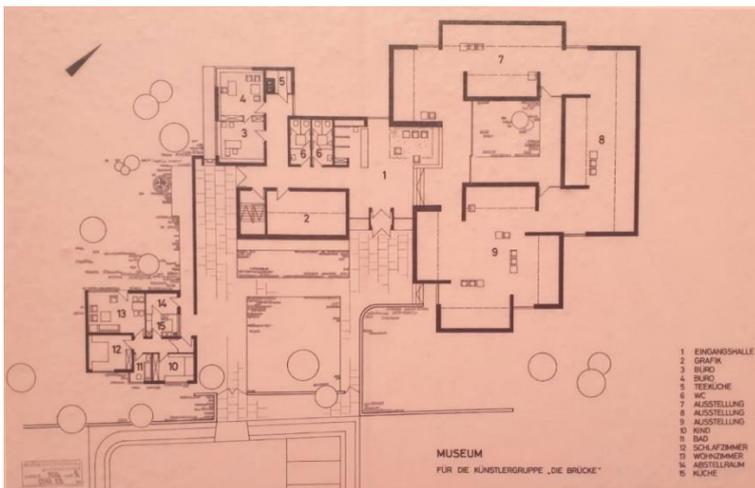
Landesarchiv Berlin: Grundriss Brücke-Museum (Werner Düttmann, Berlin 1967)
